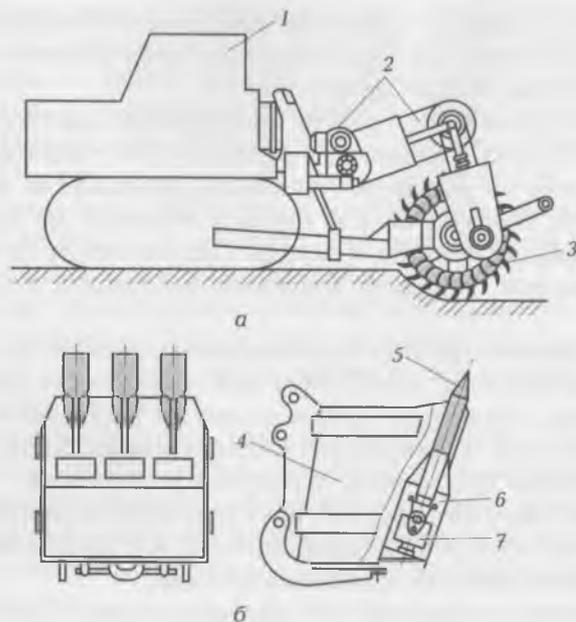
Технические средства для разработки мерзлых грунтов без предварительной подготовки:
